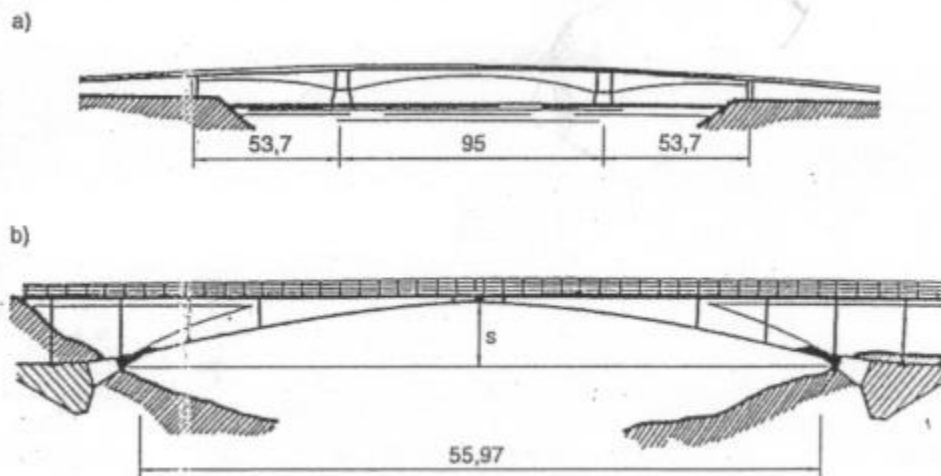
Shembuj të urave harkore prej betoni me armaturë
